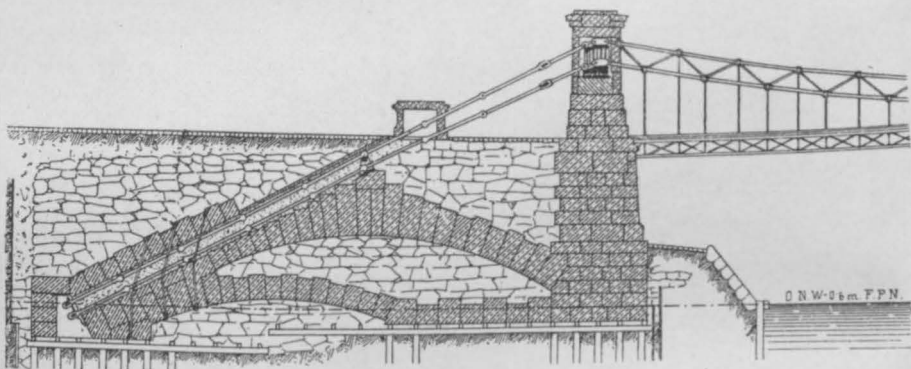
Längsschnitt durch das Ankermauerwerk der Aspernbrücke in Wien.
